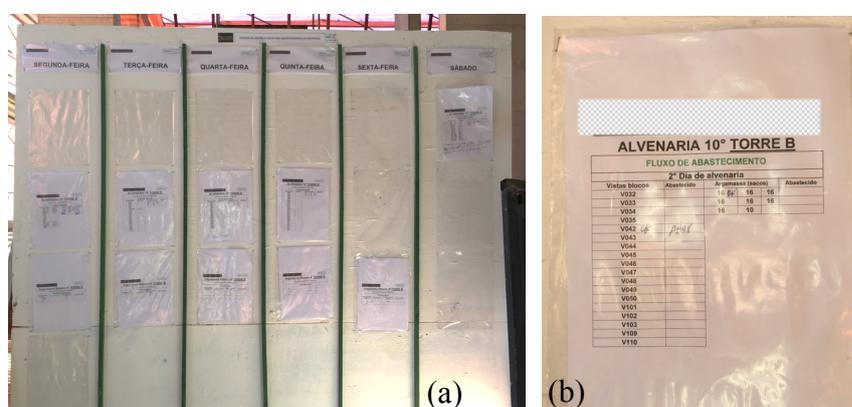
Painel de controle de abastecimento de blocos e argamassas no pavimento
